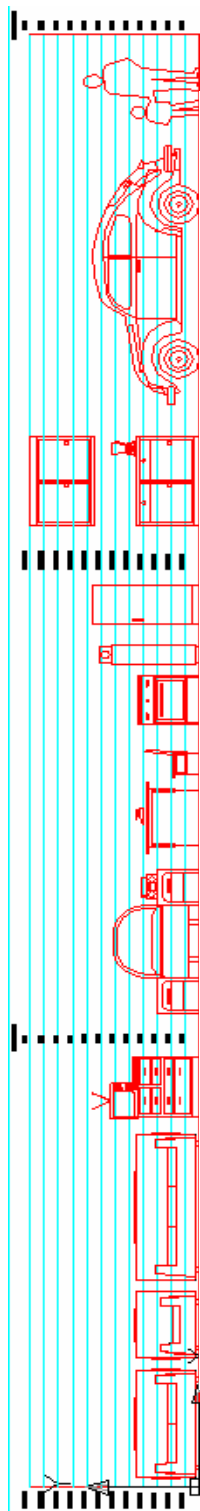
Menaje para la vivienda tipo II (una sola planta)
